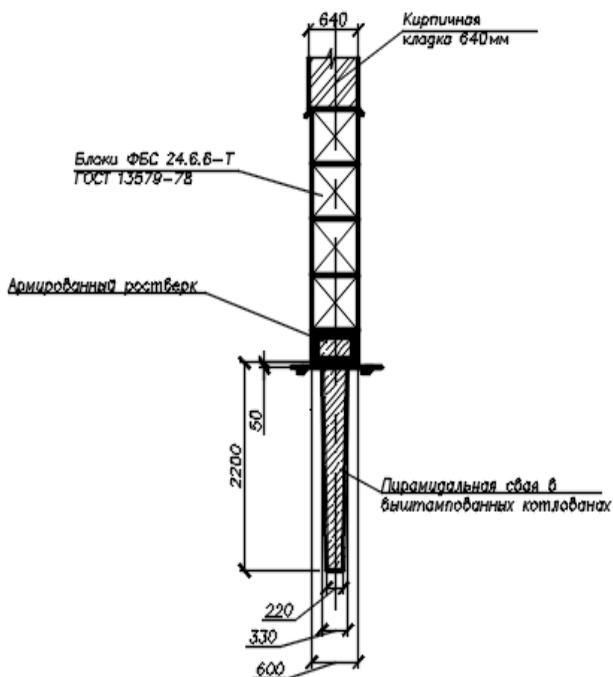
Конструктивное решение устройства фундамента на пирамидальных свая в выштампованных котлованах
